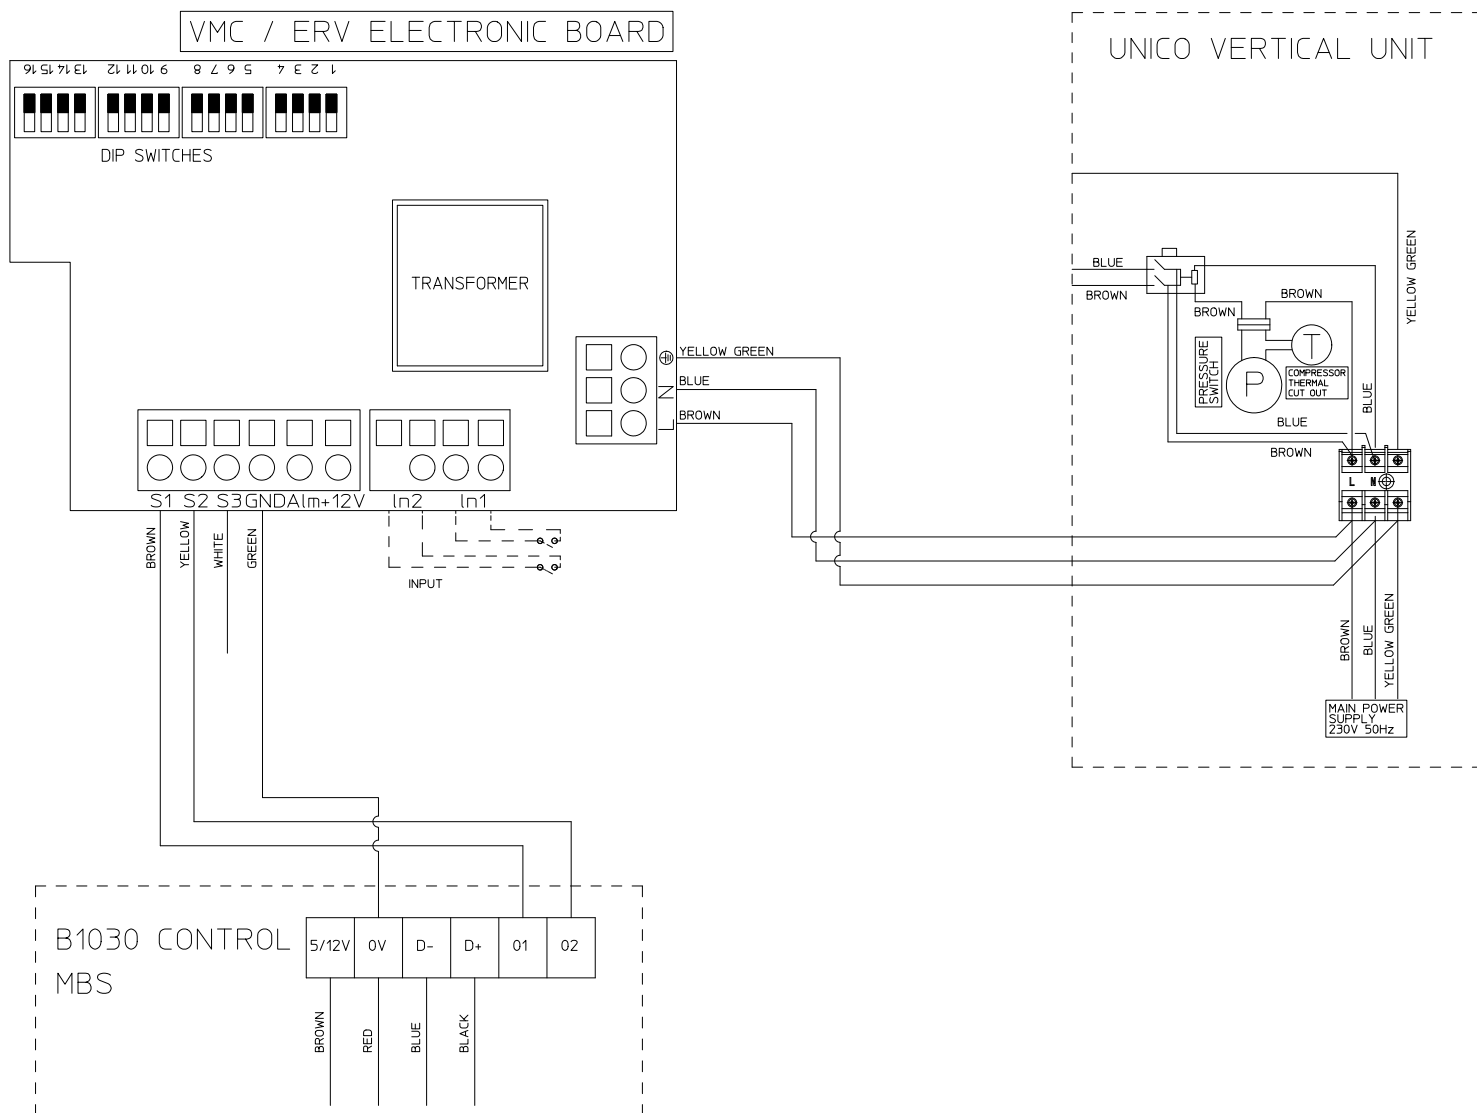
g Conexiuni electrice pe placa de bază montată în cutia de borne.
